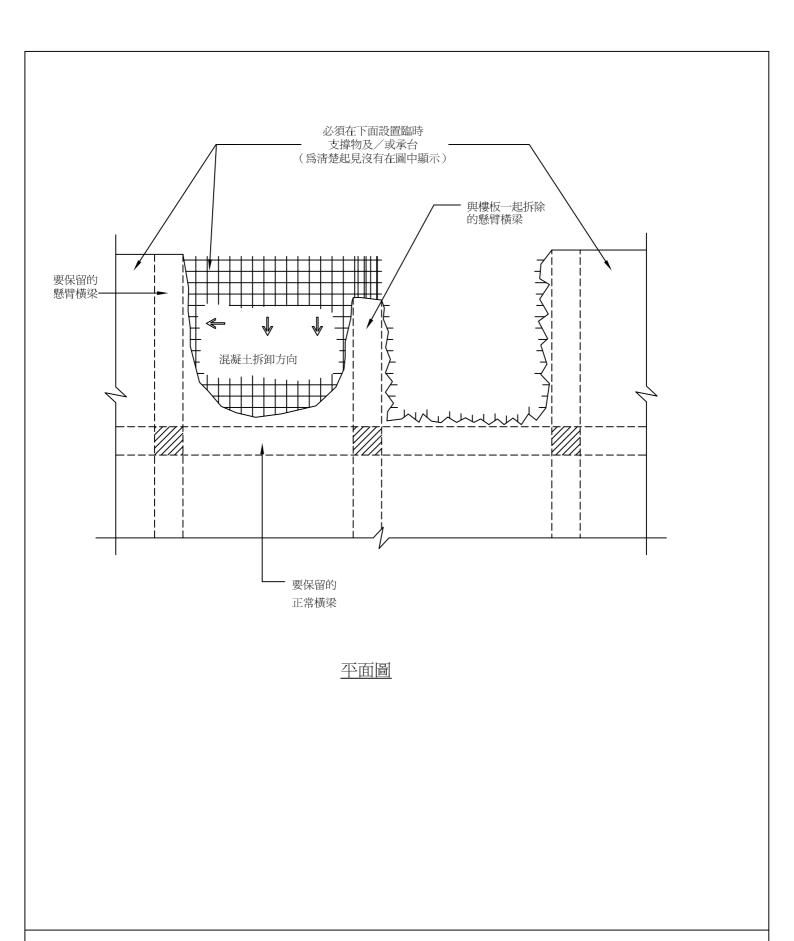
拆卸懸臂鋼筋混凝土樓板和橫梁(人工方法)
